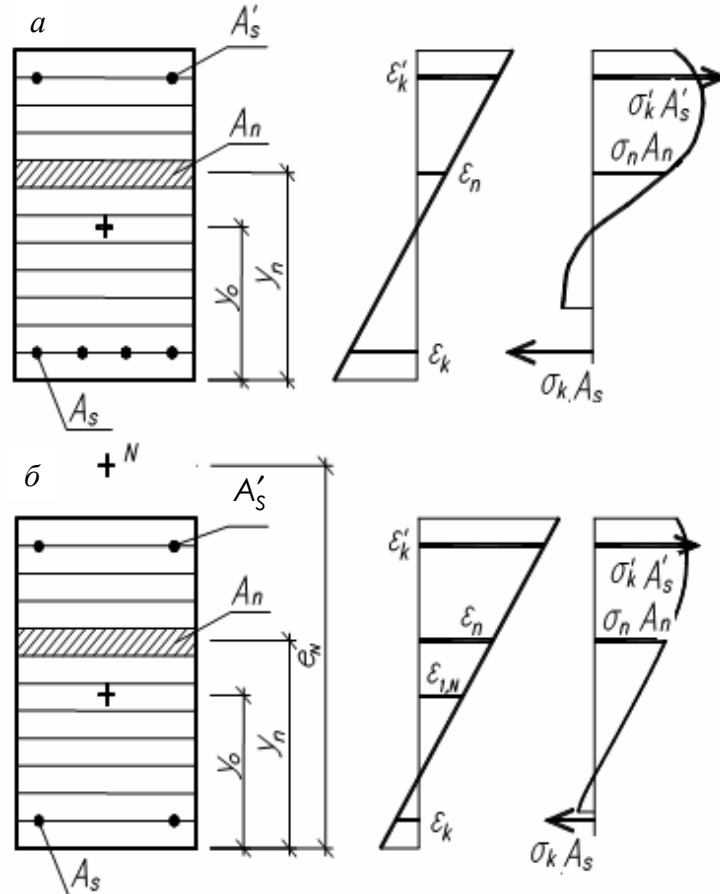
Расчетное поперечное сечение и распределение деформаций и напряжений:  $a$  – изгибаемого железобетонного элемента;  $b$  – внецентренно сжатого
